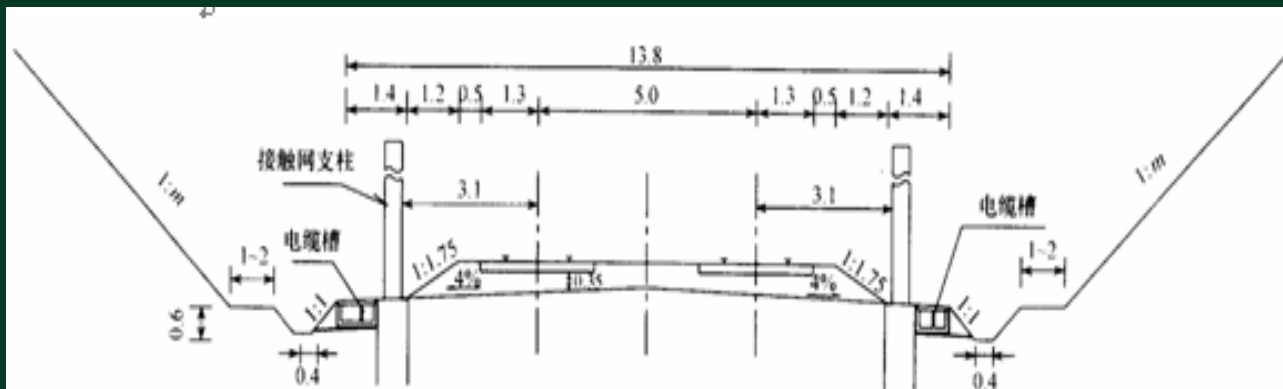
双线路堑（硬质岩石）标准横断面示意图（单位：m）
